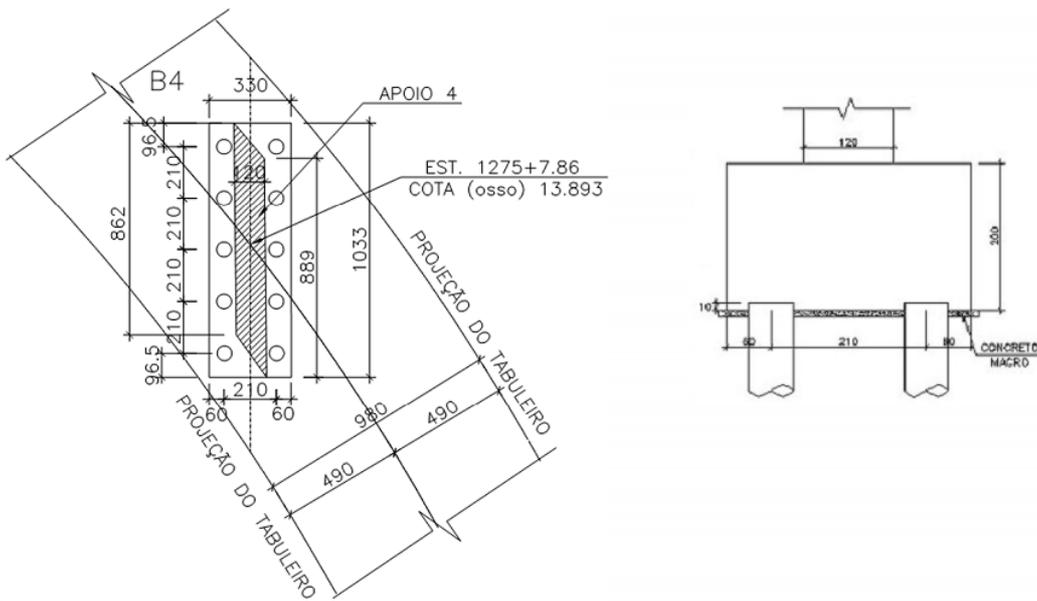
Geometria original do Bloco que foi reforçado. (Fonte: VITÓRIO, 2014)
